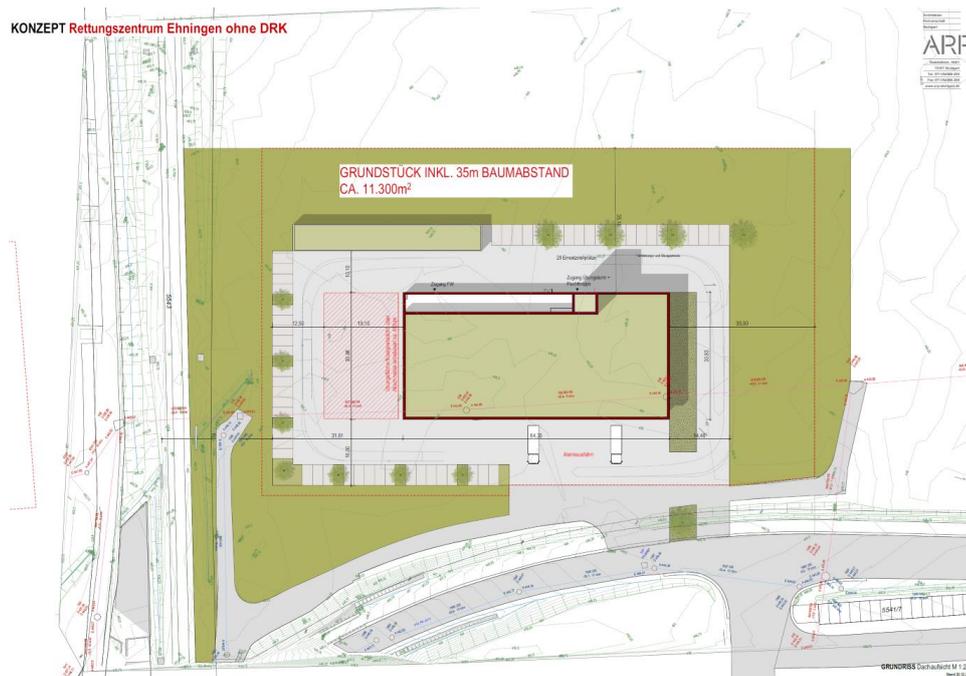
Vorentwurf Lageplan, 20.12.2022 ARP Stuttgart
